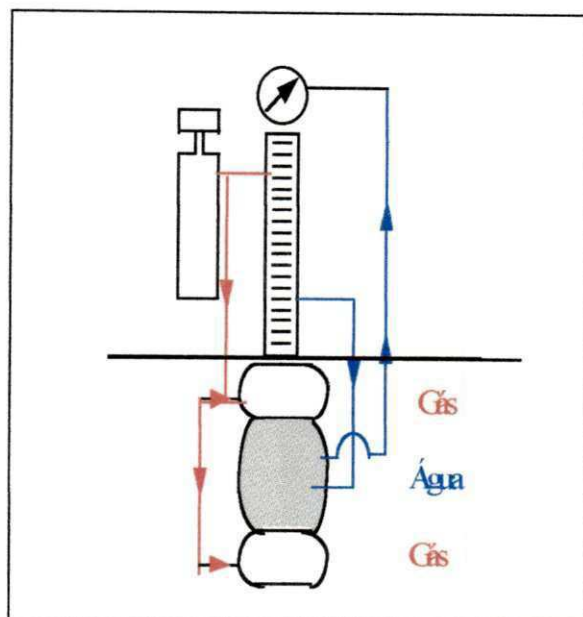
Croqui do pressiômetro Ménard tipo E.
